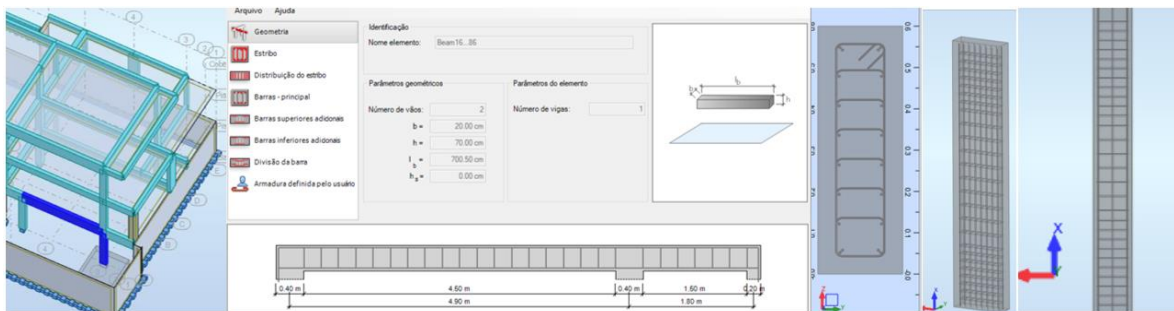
Pormenorização de armaduras em viga e pilar (*Robot*).
